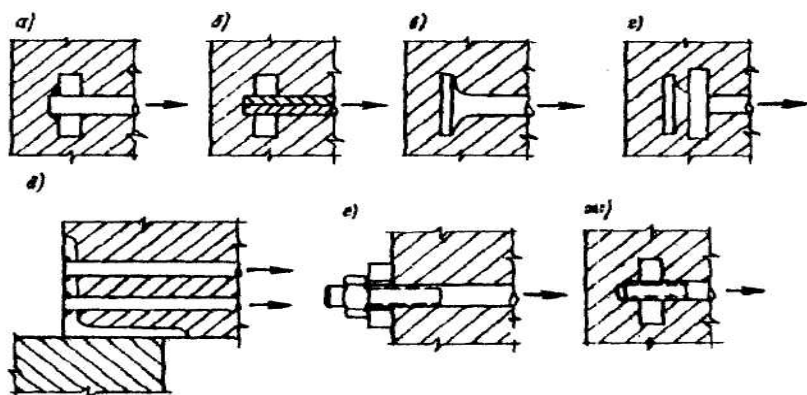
Анкеровка арматуры путем устройства на концах специальных анкеров, в виде а - приваренной пластины; б - обжатой пластины; в - высаженной головки; г - высаженной головки с шайбой; д - приваренного стержня к уголку; е - гайки с шайбой снаружи; ж - гайки внутри
